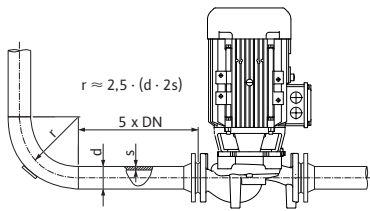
Section de stabilisation en amont et en aval de la pompe
